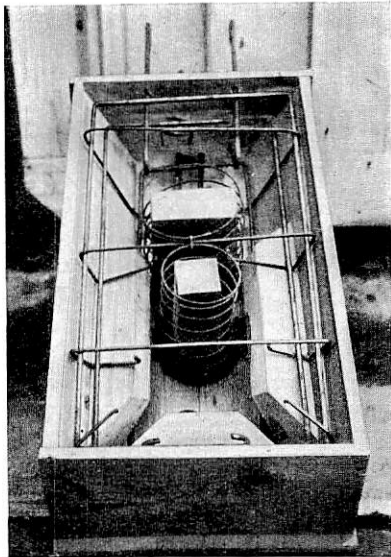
Schalform mit Armatur fertig zur Betonierung.
